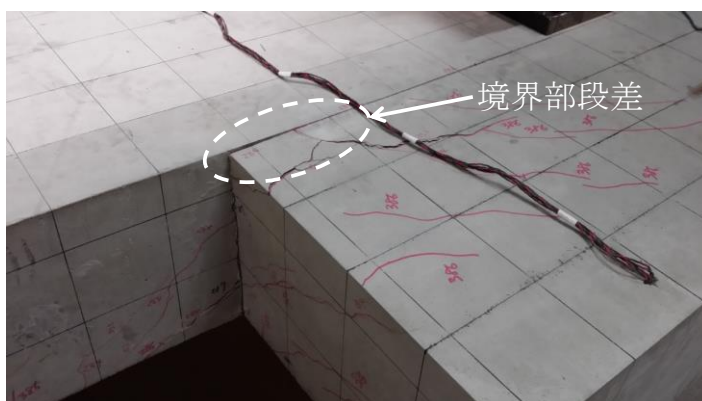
補強はり端部ひび割れ性状 (No.18)
